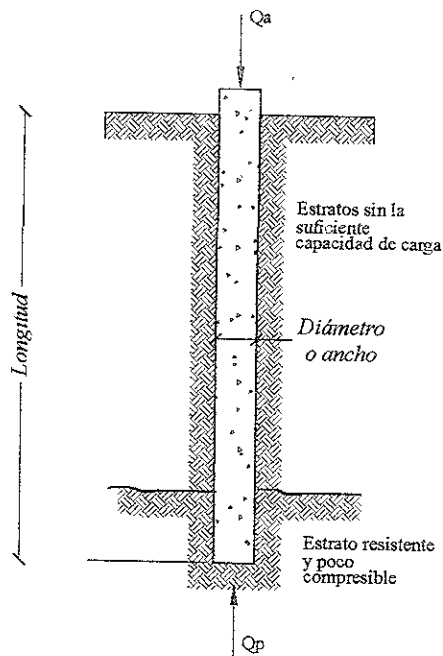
Cimentación profunda resuelta con pilotes de punta
